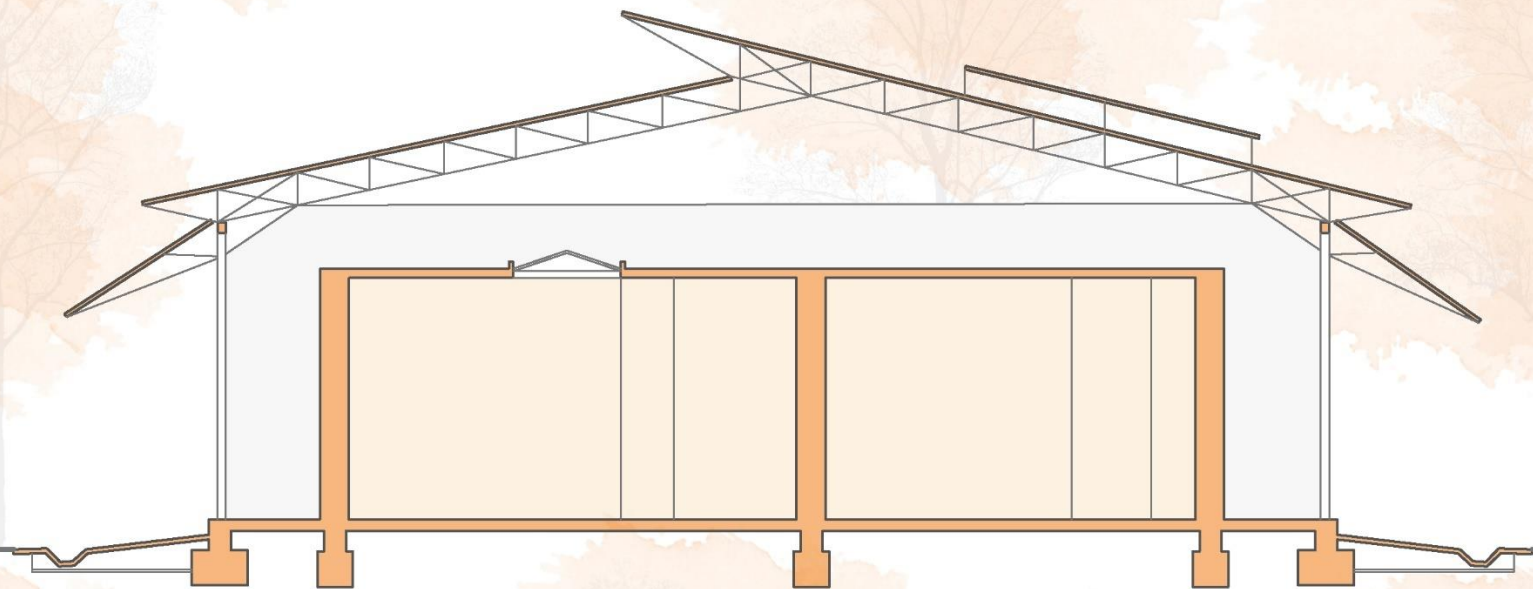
VISTA EXTERIOR: ZONA CUBIERTA EXTERIOR
